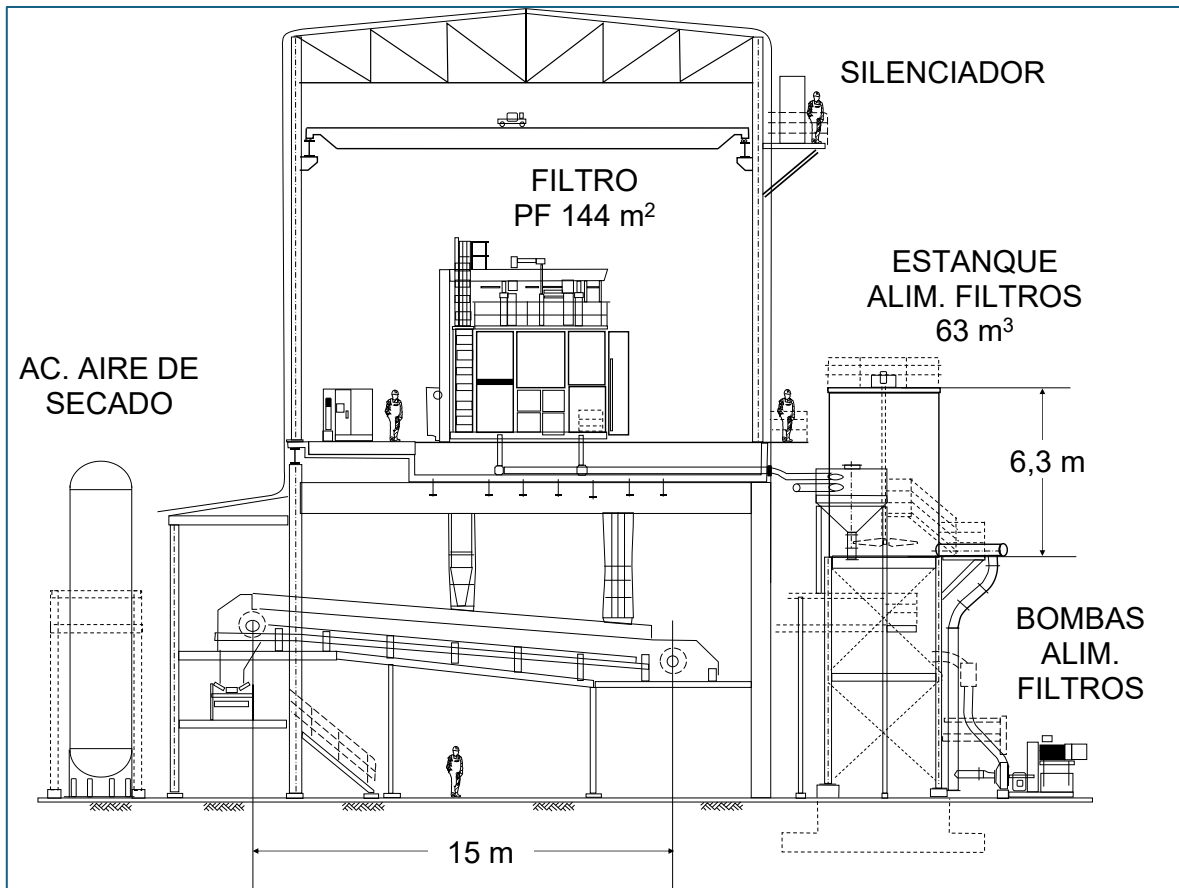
Planta de Filtros Coloso Filtro Larox PF-04
